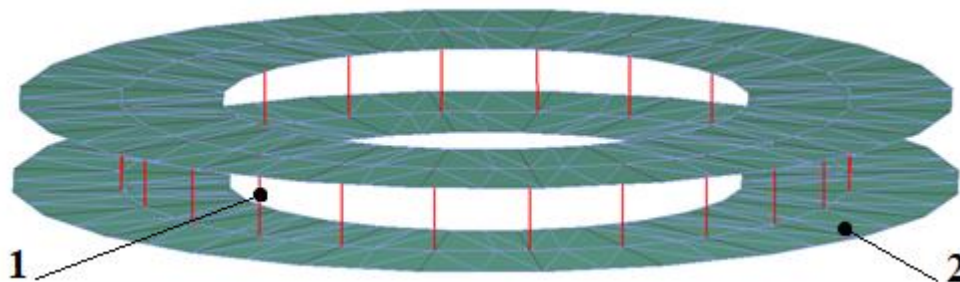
Фрагмент расчётной модели: 1 – включающиеся трубные связи; 2 – подвешенные перекрытия
